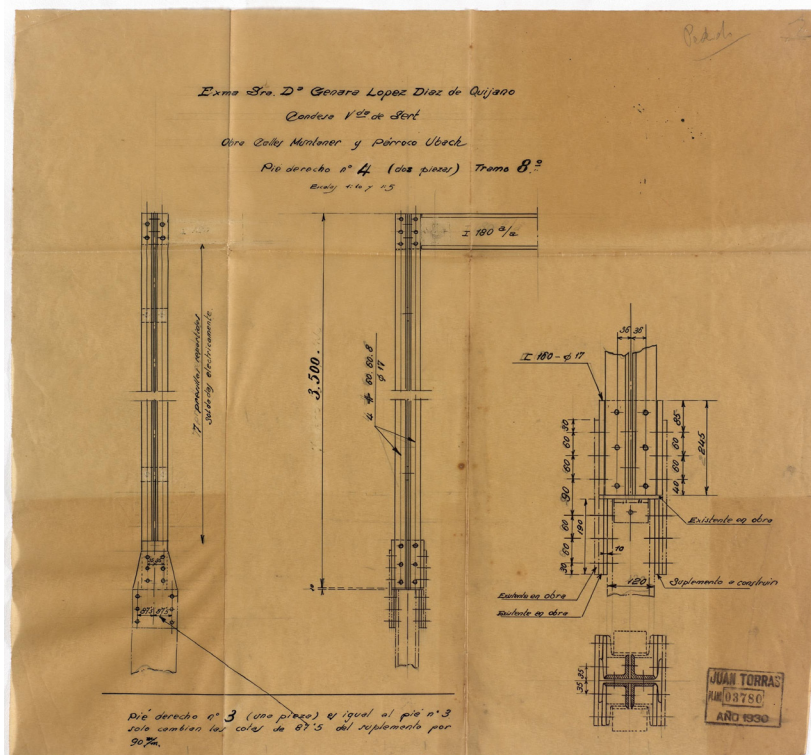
Detalle estructural transición pilar doble C, con el pilar en forma de cruz usado en la planta ático, en el espacio destinado a estudio de Josep Lluís Sert. Obras calle Muntaner y Rector Ubach. 1930. Plano 3780. Torras Herre-rías y Construcciones SA. ANC
